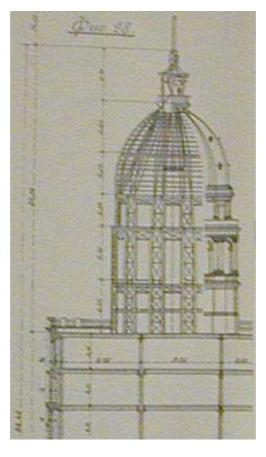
Фрагмент конструкции здания World Building в Нью-Йорке
